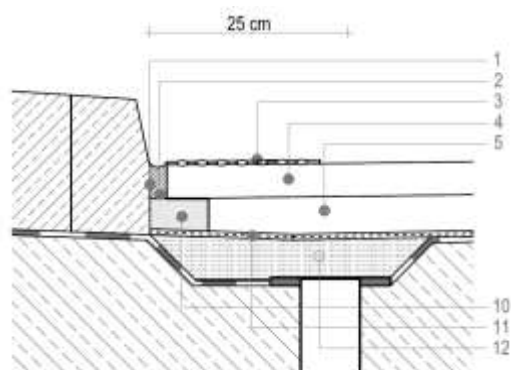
Hidroizolacija konstrukcije uz ivicu kolovoza
